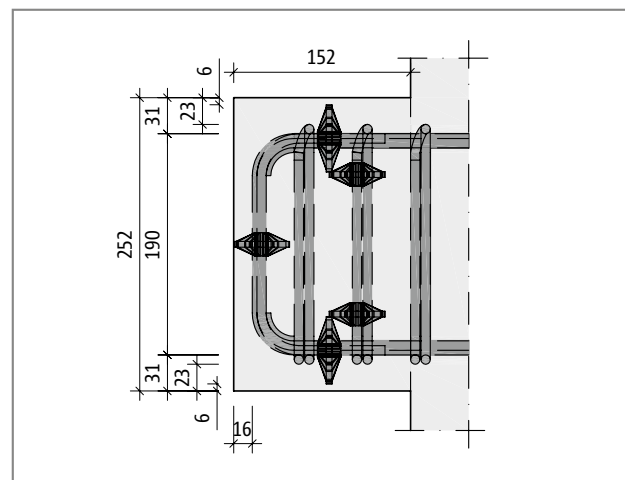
Schöck Tronsole® type Z: Plan view of a concrete landing with integrated load-bearing element
